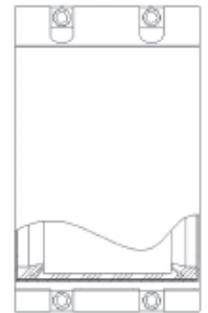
/ Installation d'un point de inspection dans un conduit du grand diamètre.
